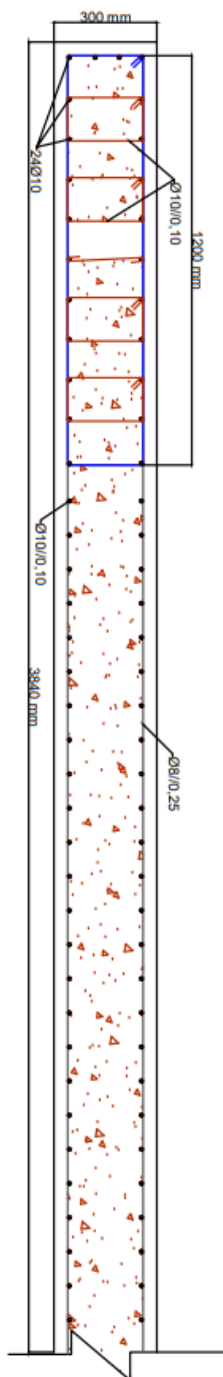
Secção Transversal da PA.1 desde o piso das fundações até ao piso 4
